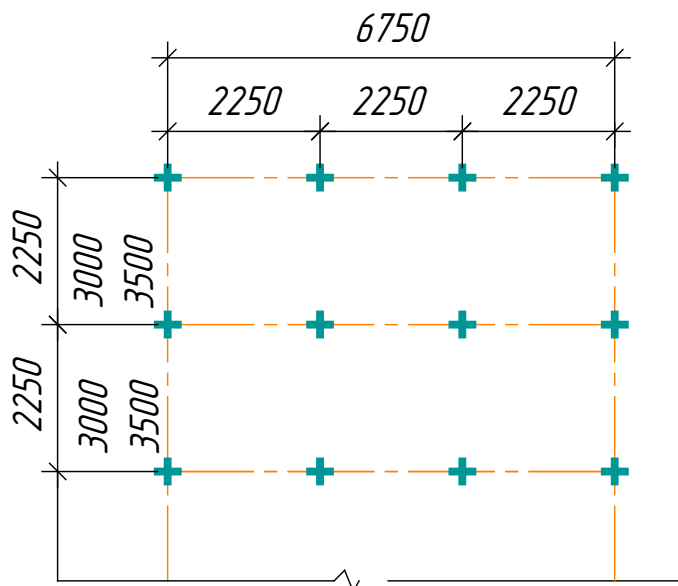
Схема плана свайного поля (точное расположение свай определяется расчетом)
